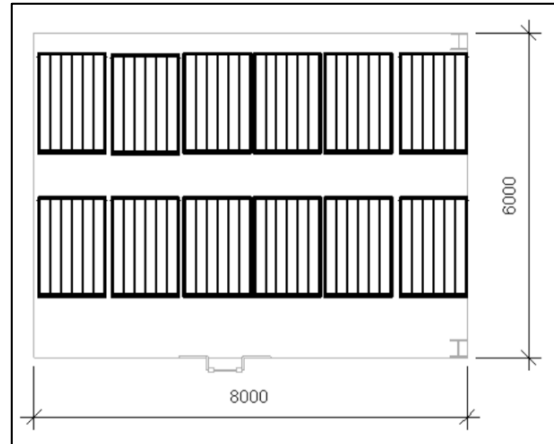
Vista de planta piso 1. Central de producción plataforma N°2.
